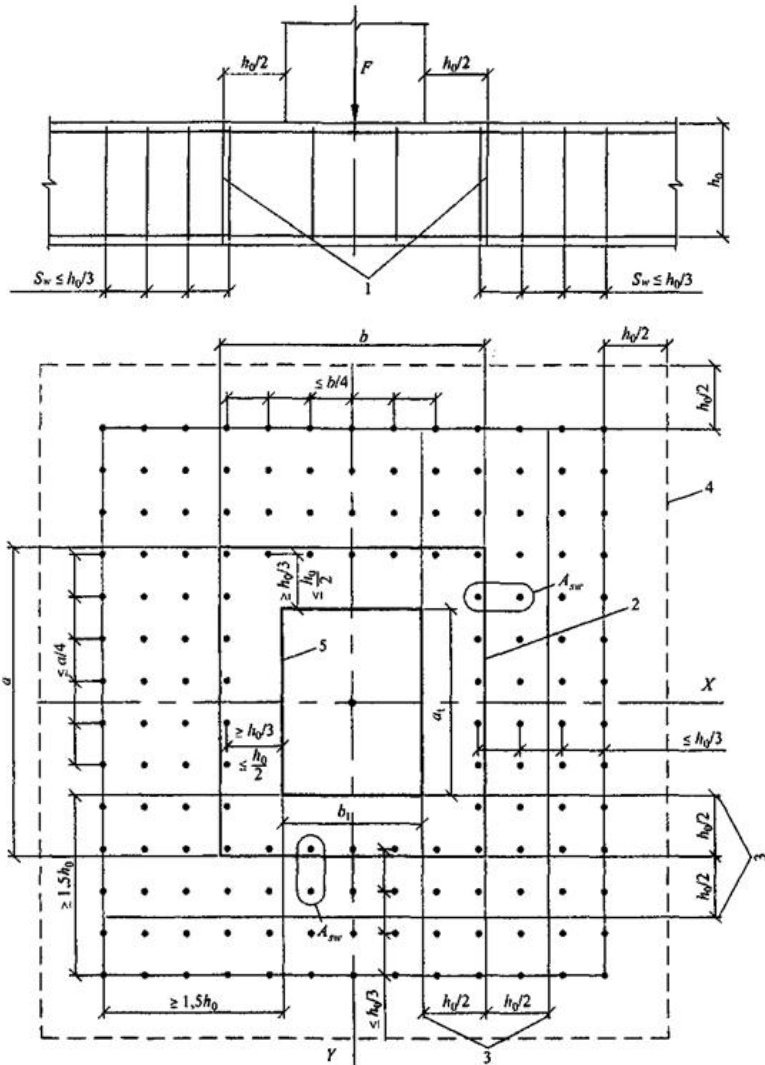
Схема для расчета железобетонных плит с вертикальной равномерно распределенной поперечной арматурой на продавливание: 1 – расчетное поперечное сечение; 2 – контур расчетного поперечного сечения; 3 – границы зоны, в пределах которых в расчете учитывается поперечная арматура; 4 – контур расчетного поперечного сечения без учета в расчете поперечной арматуры; 5 – контур площадки приложения нагрузки
